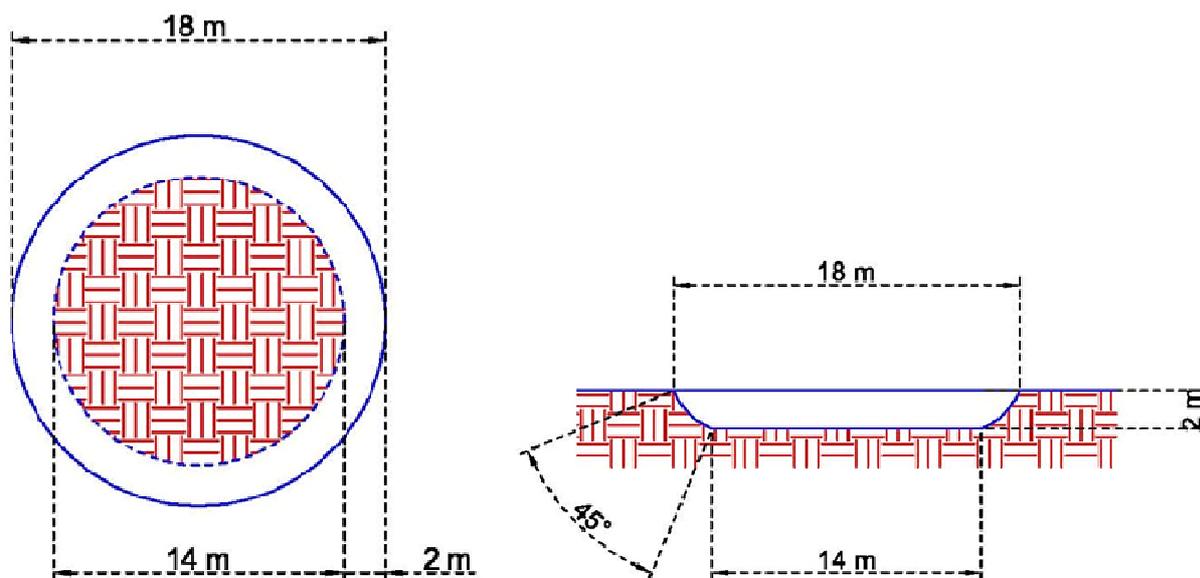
Layout em planta e corte das barraginhas e suas dimensões
